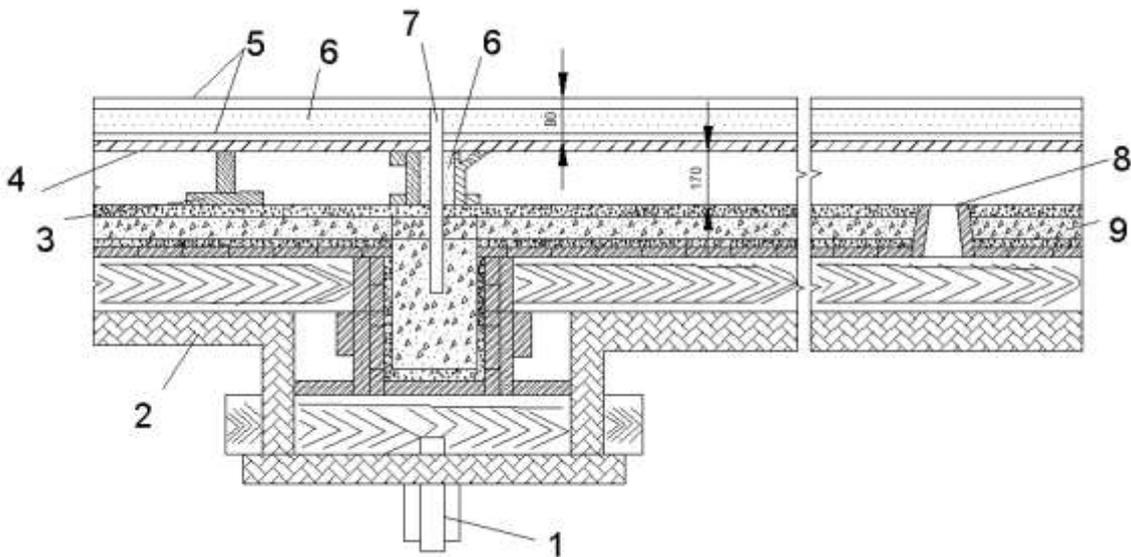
Схема паровой рубашки для прогрева железобетонных ребристых перекрытий.
